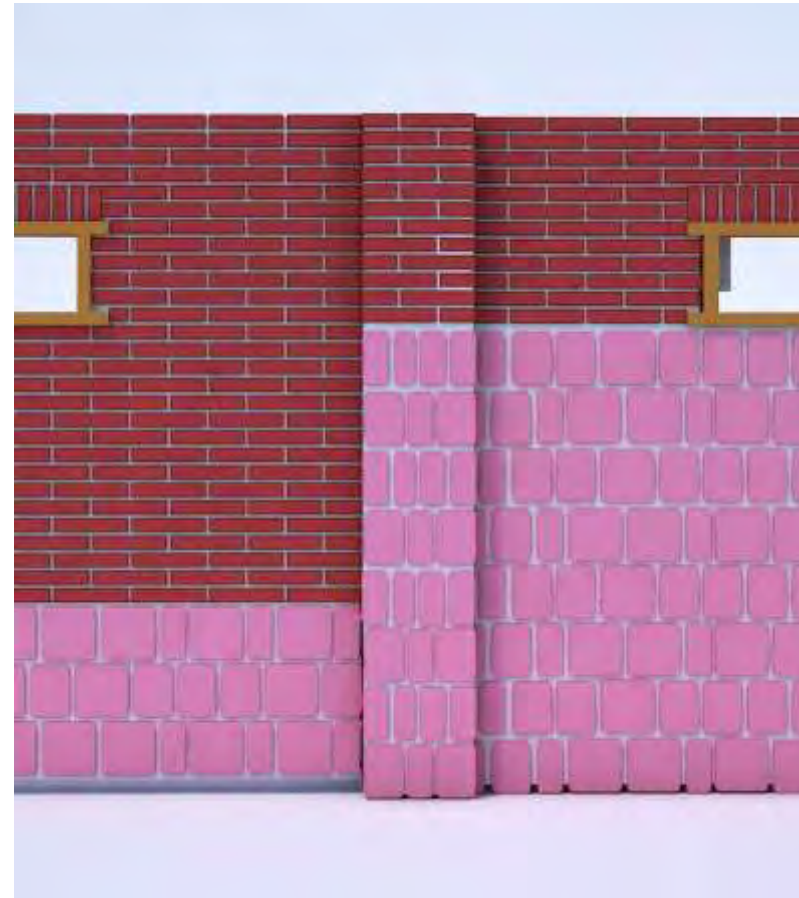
Representación de muro de ladrillo y piedra braza, mostrando una disposición diferente en la construcción de muros.
